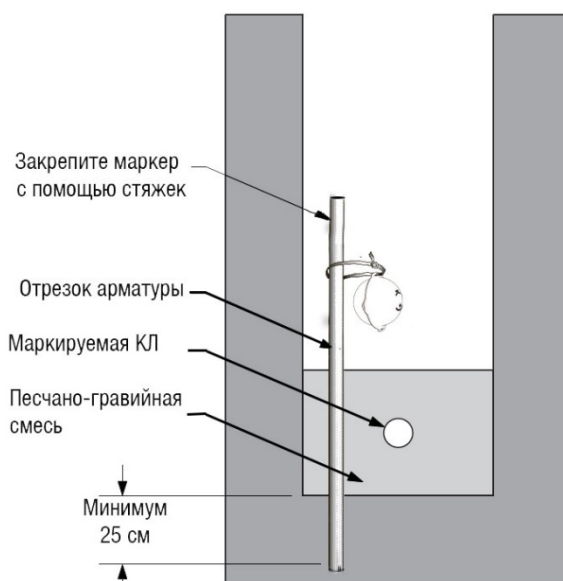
Установка маркера OmniMarker с креплением к вертикальному стержню
